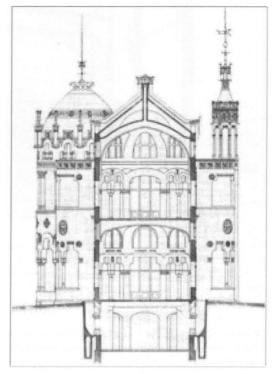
Sección transversal del pabellón de San Manuel (AHSCP)
